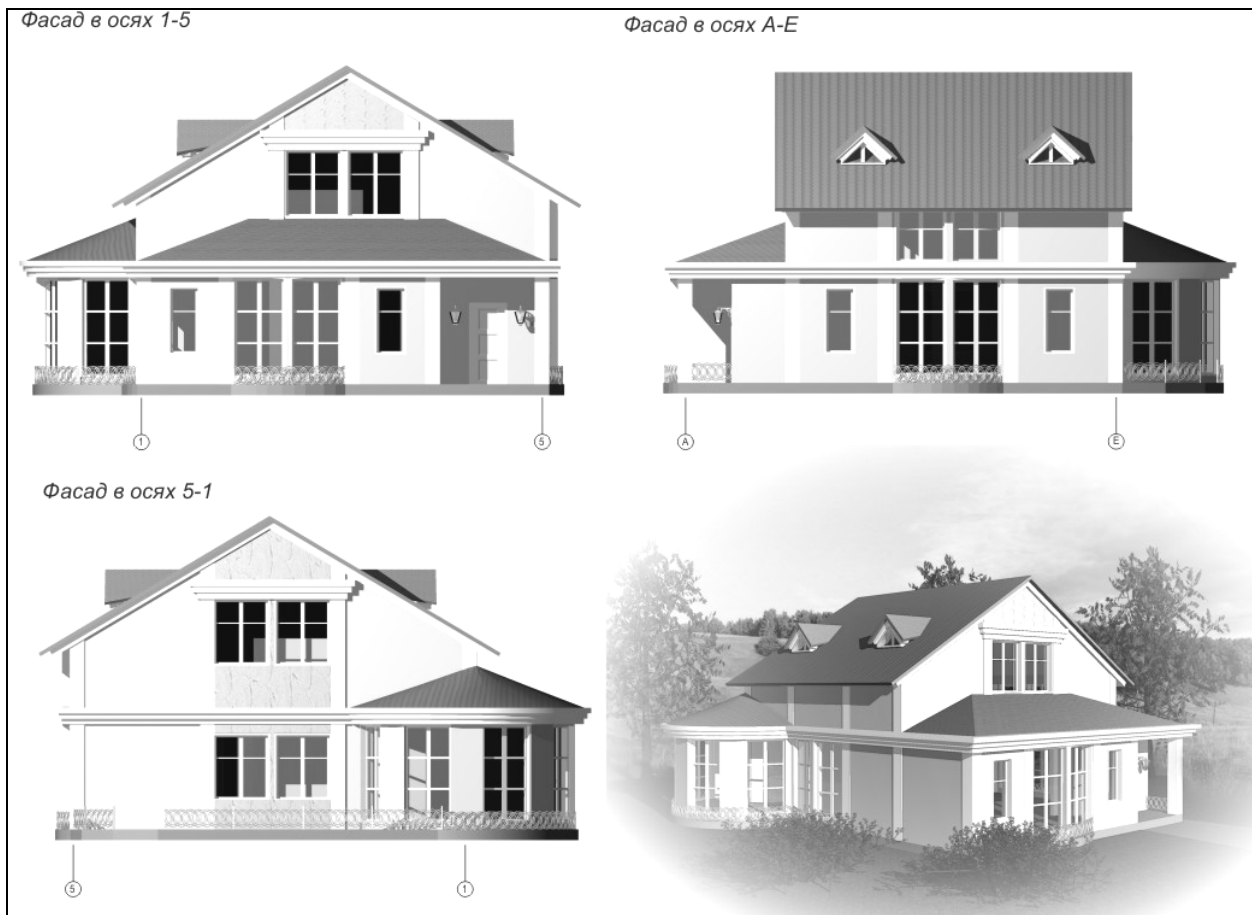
Фасады, общий вид, планы этажей коттеджа площадью 212 кв.м
